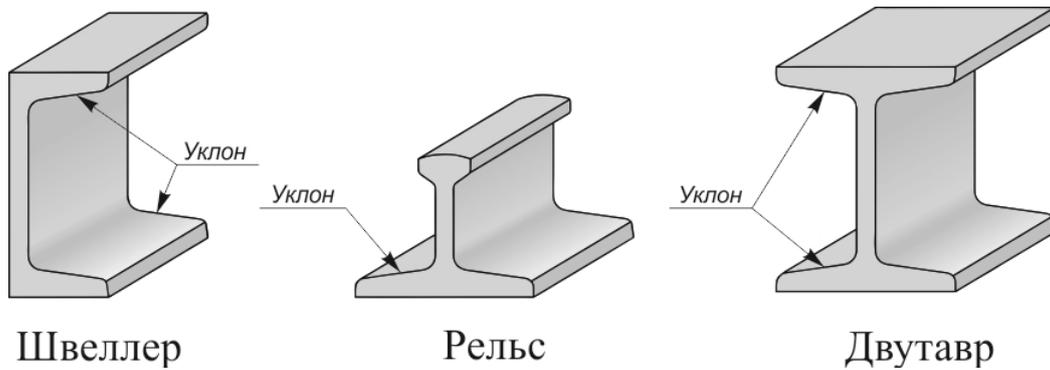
Стальной фасонный прокат для металлоконструкций
